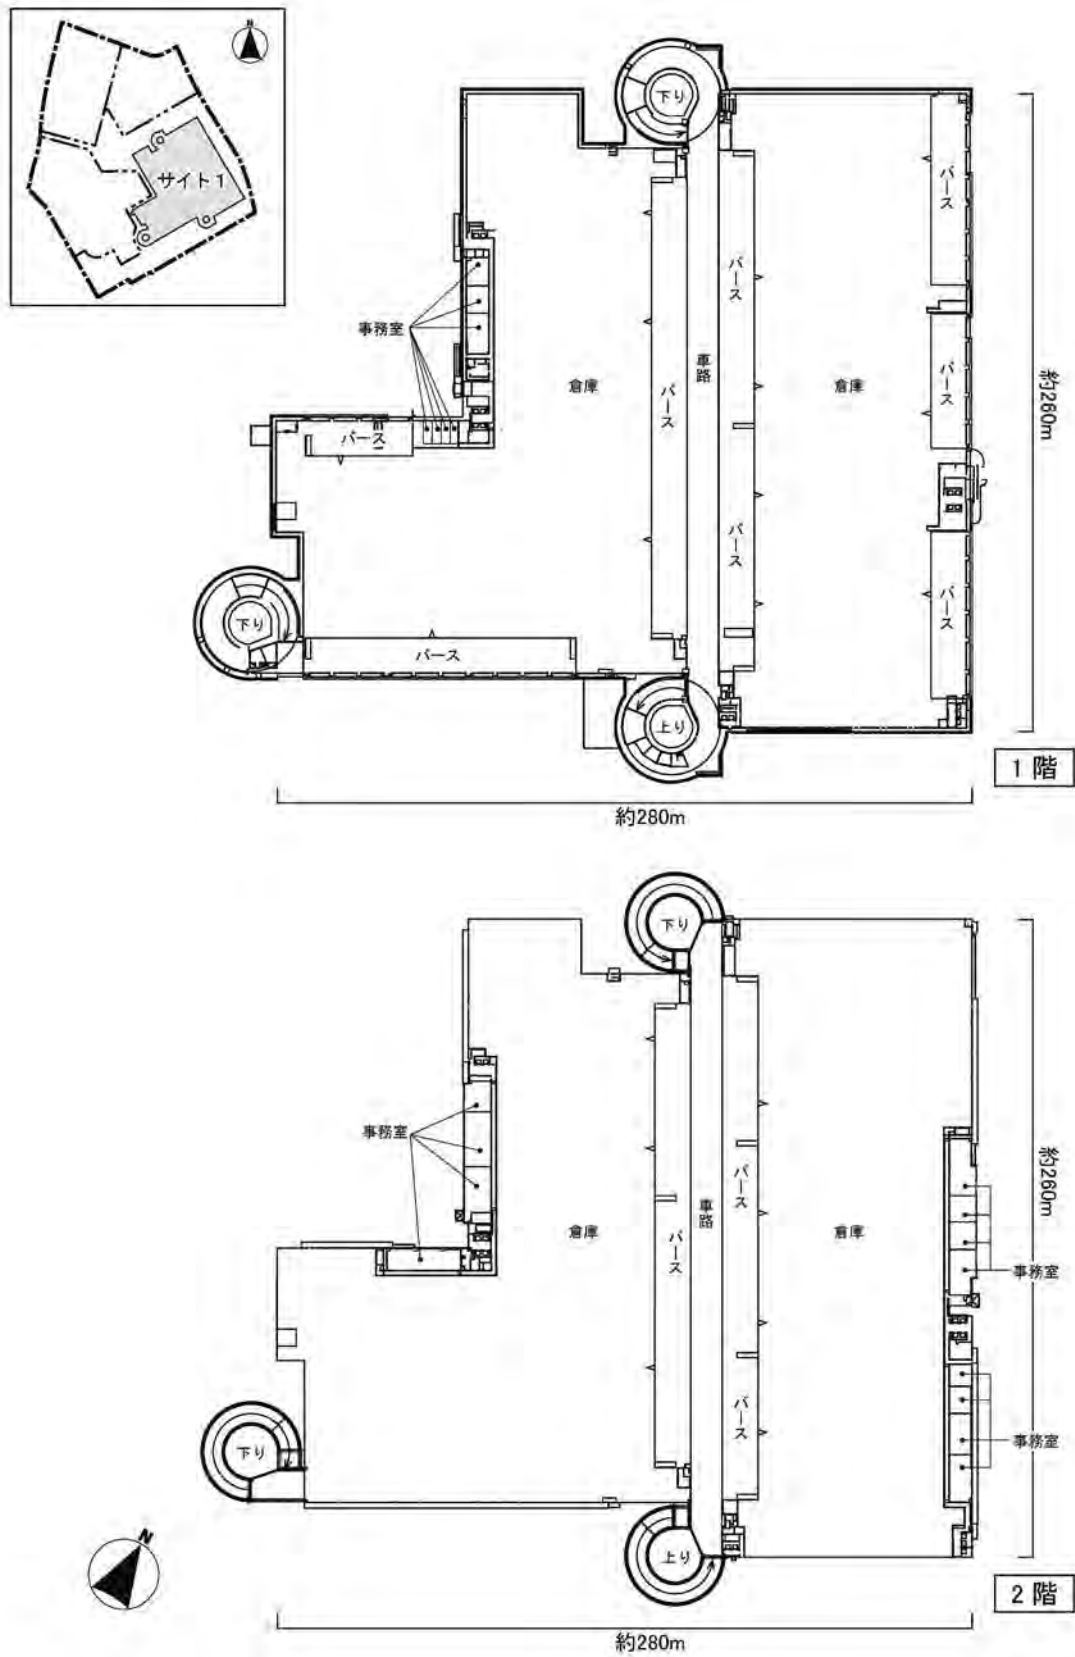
(1) 平面図 (サイト1【1階・2階】)
